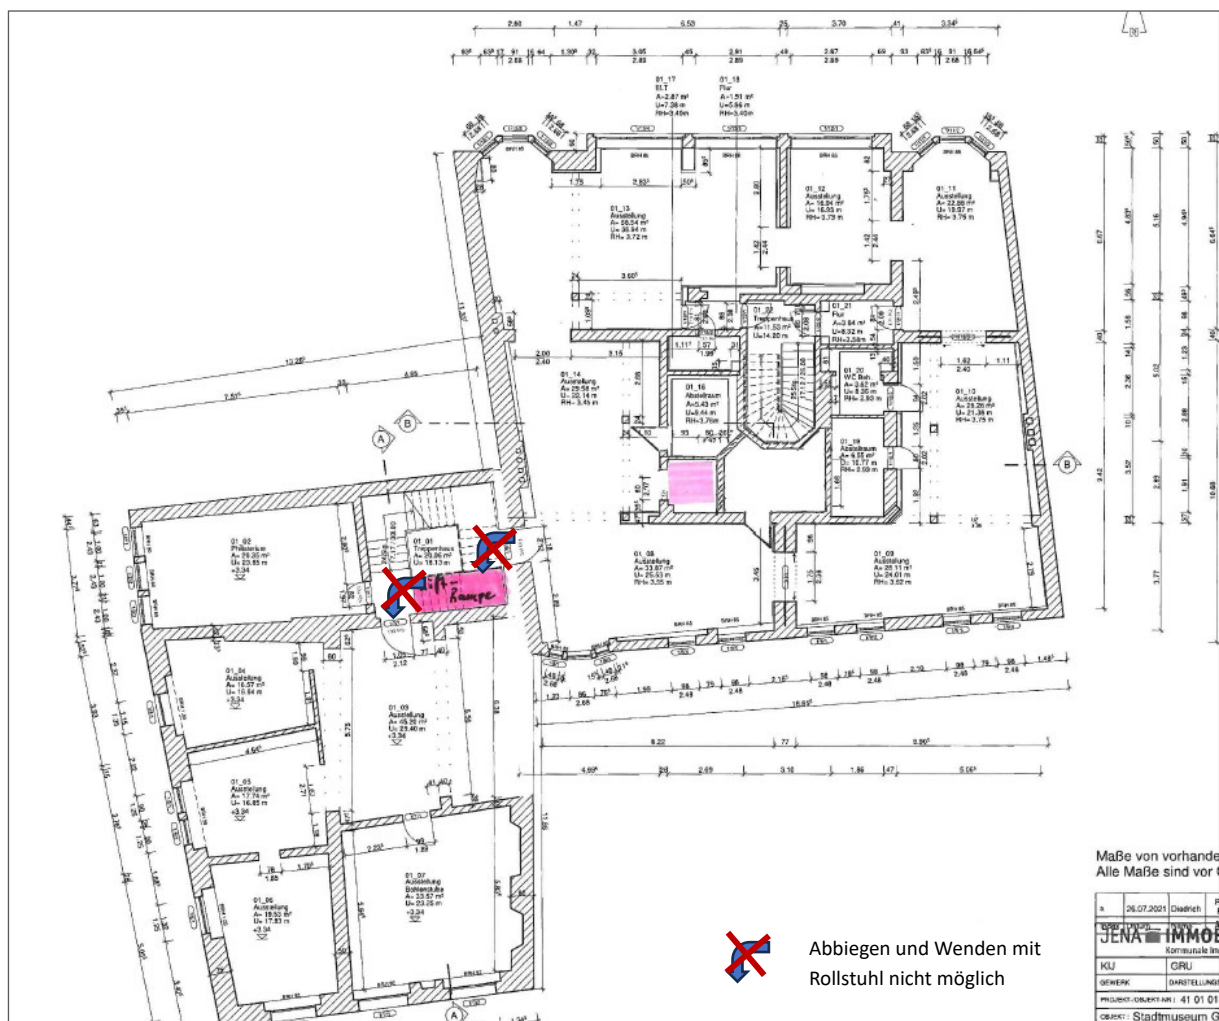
Grundriss 1. Obergeschoss Positionierung Aufzug, Variante Treppenhaus Alte Göhre, ergänzt;
